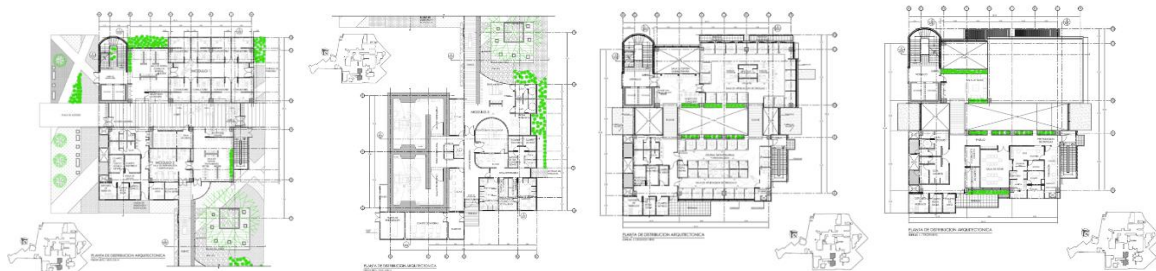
Radioterapia Hospital México, CCSS-CR (2013). Plantas de distribución arquitectónica. Archivo PRO-DAPEI-GIT. Archivo del autor (2013).
